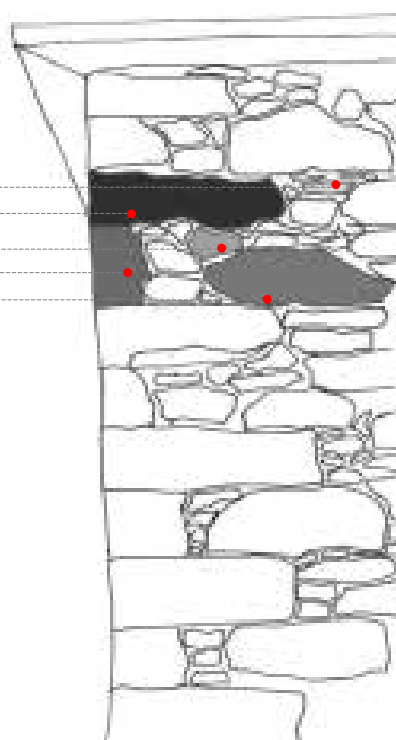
Esquema das pedras da parede exterior das casas de salão. (Ilustração nossa, 2016).
